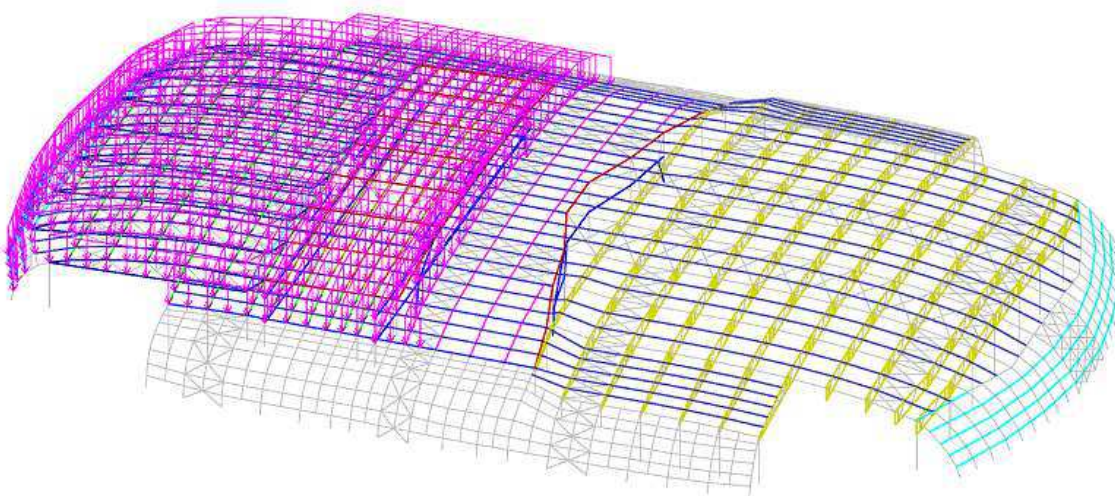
Схема загрузки снеговой нагрузкой на  $\frac{1}{2}$  длины покрытия (загрузка 6)
